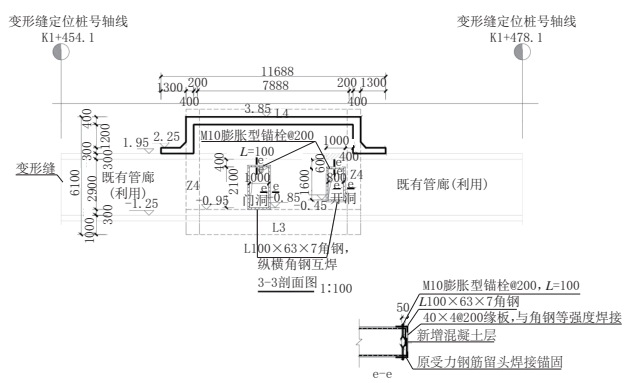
单舱接双舱节点细部构造(开洞、利用)示意图(单位:mm)
